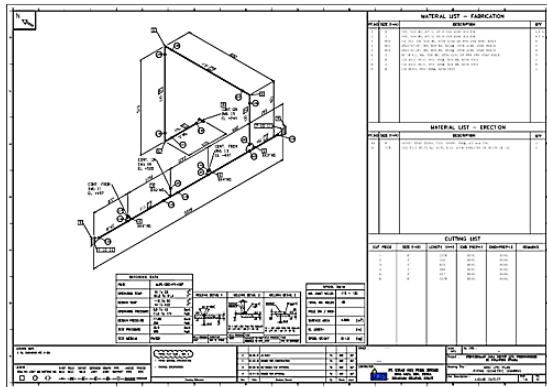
Mini LPG Plan Piping Isometric Drawing 3
